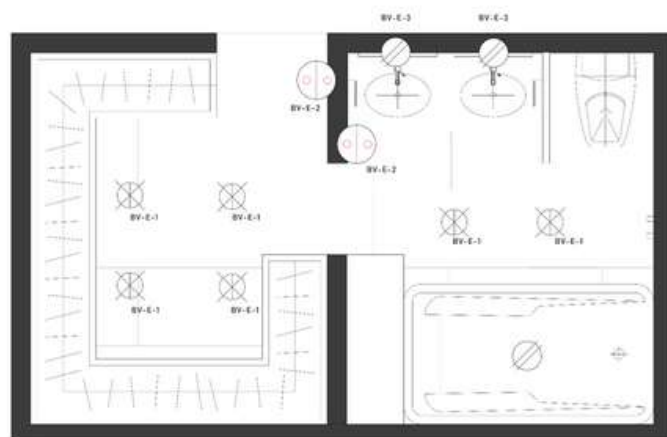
Planta de baño instalaciones eléctricas. Fuente: Autoría propia.
